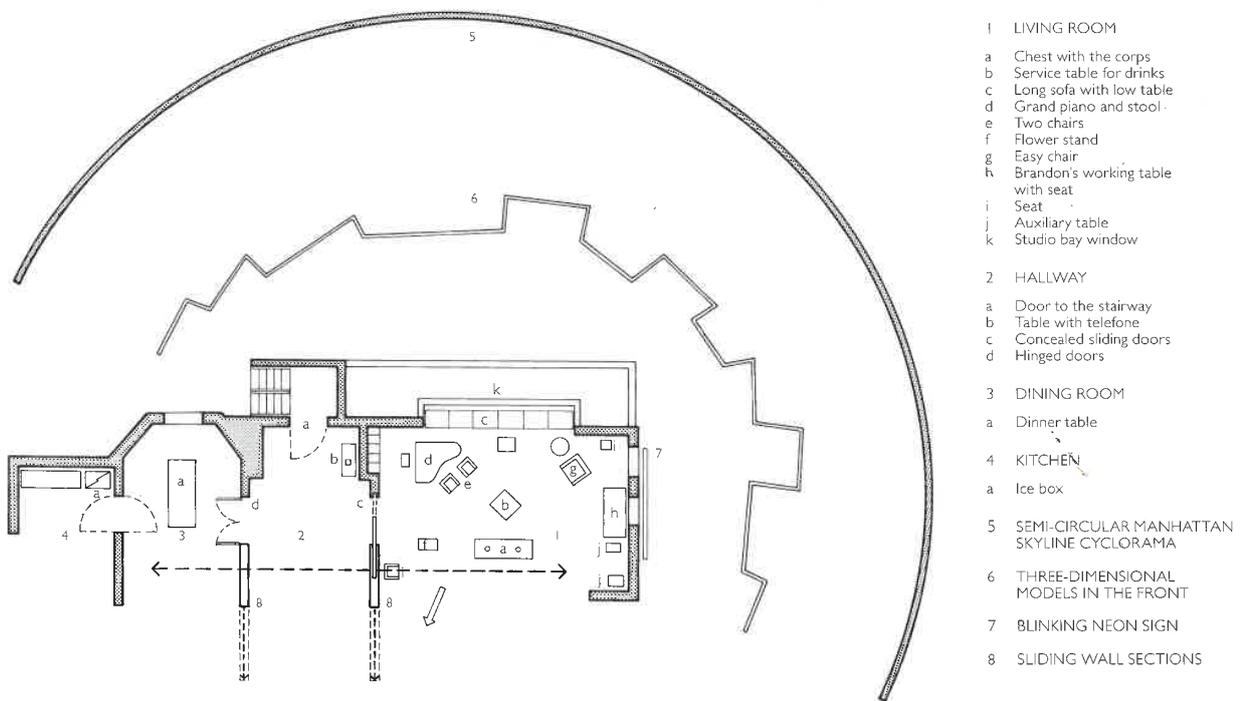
Planta esquemática de organização espacial, "Rope" (1948)
